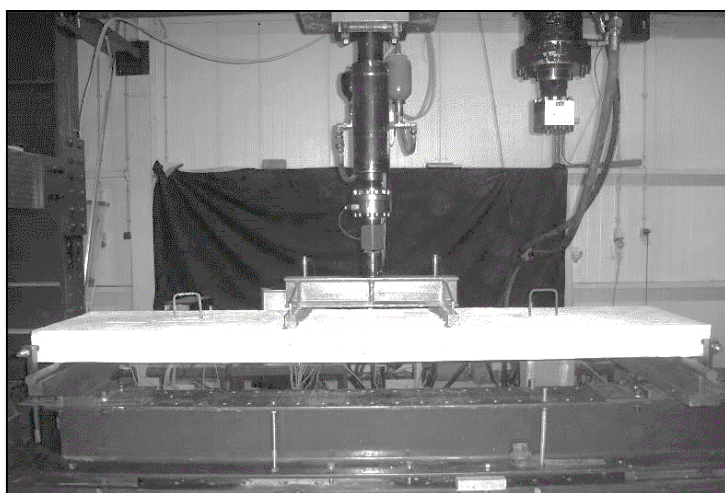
Esquema geral do ensaio das lajes de betão armado.
